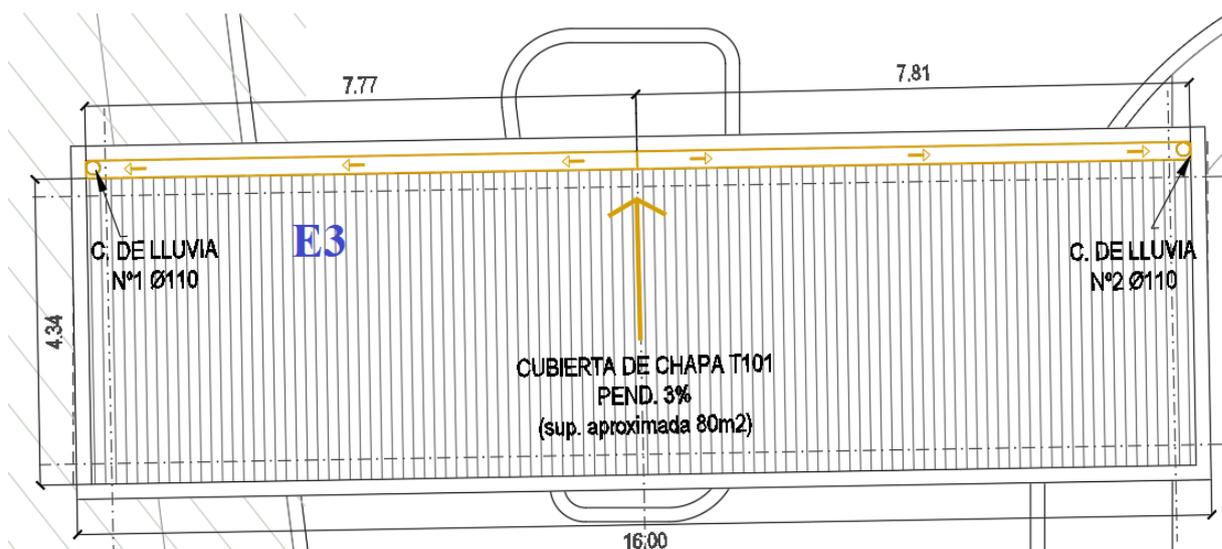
Planta de techos, Edificio E3 a desaguar en paso fronterizo La Quiaca - Provincia de Jujuy
